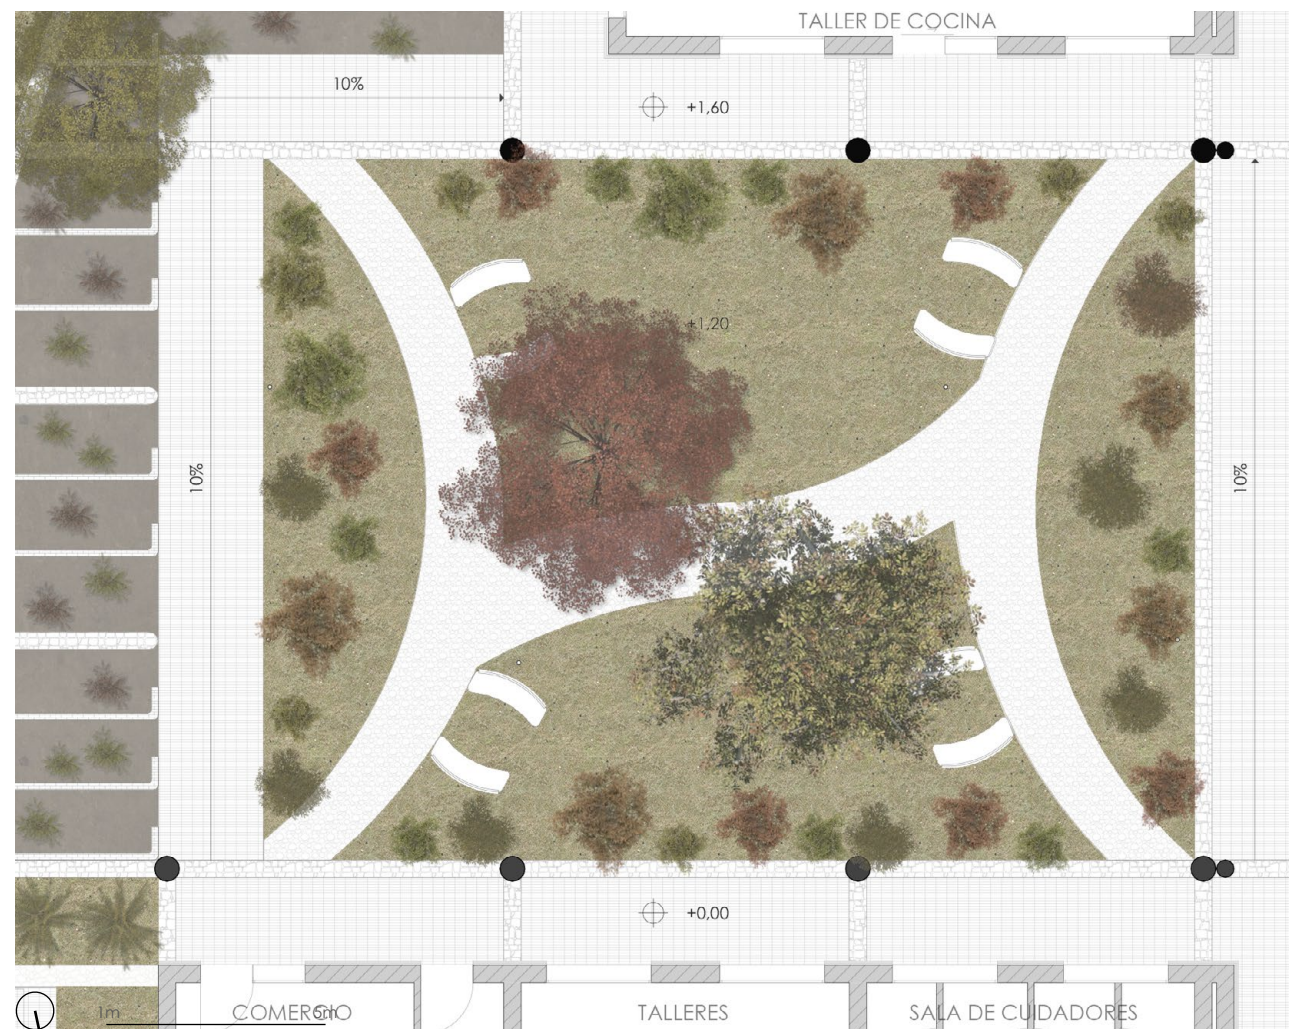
Planta Jardín Terapéutico Tipo. Fuente: Autoría propia.
